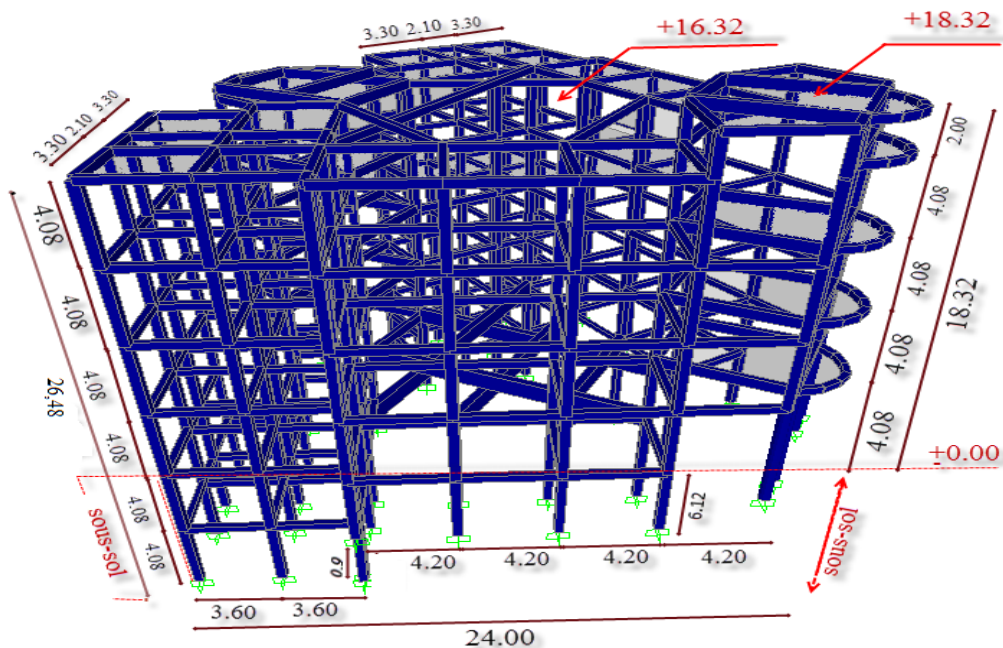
Vue en 3D de la structure existante (auto stable)
